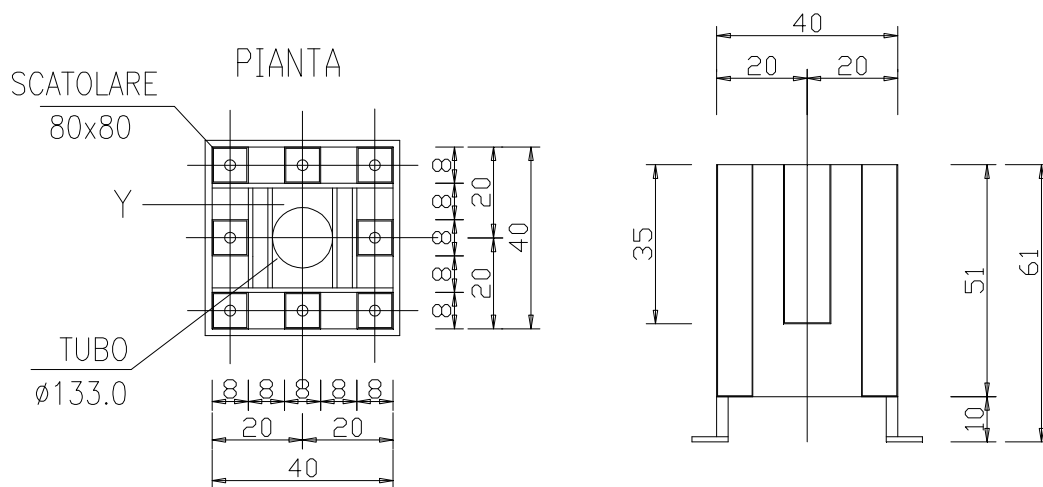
Pianta e sezione trasversale del trespolo in acciaio annegato nel getto della fondazione.
